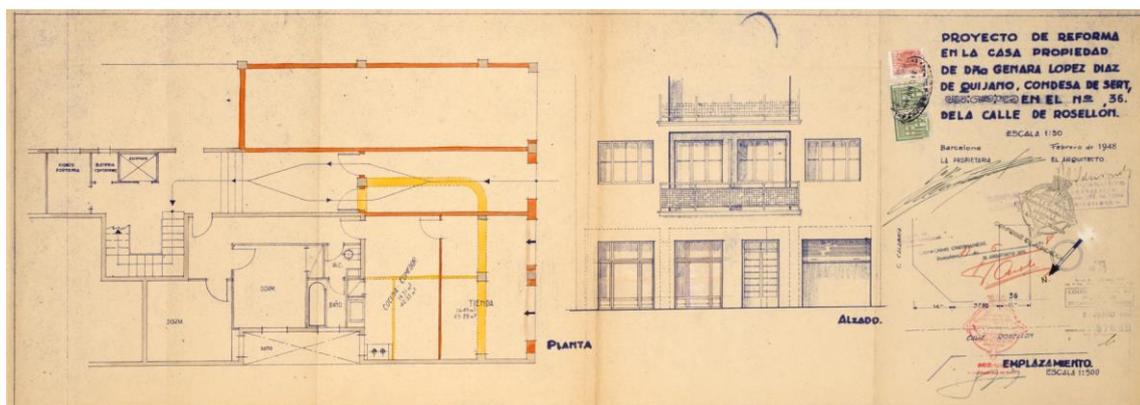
Plano de la reforma de la planta baja de Nilo Tusquets de 1948. Expte. 22893/1952. 1952. Papel. Arxiu Contemporani de Barcelona.
